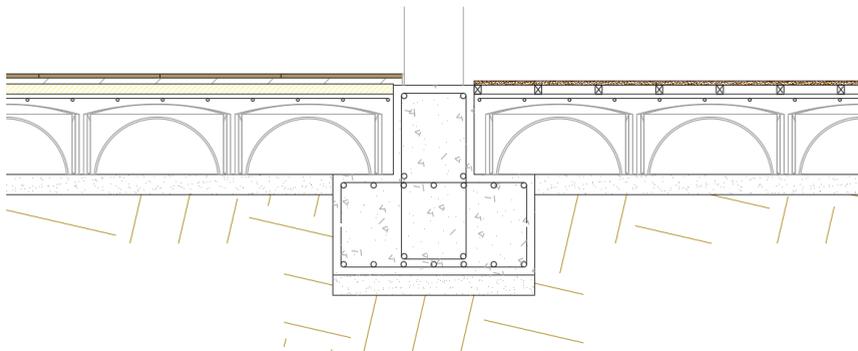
Detalle constructivo de zapata corrida. Elaboración propia
